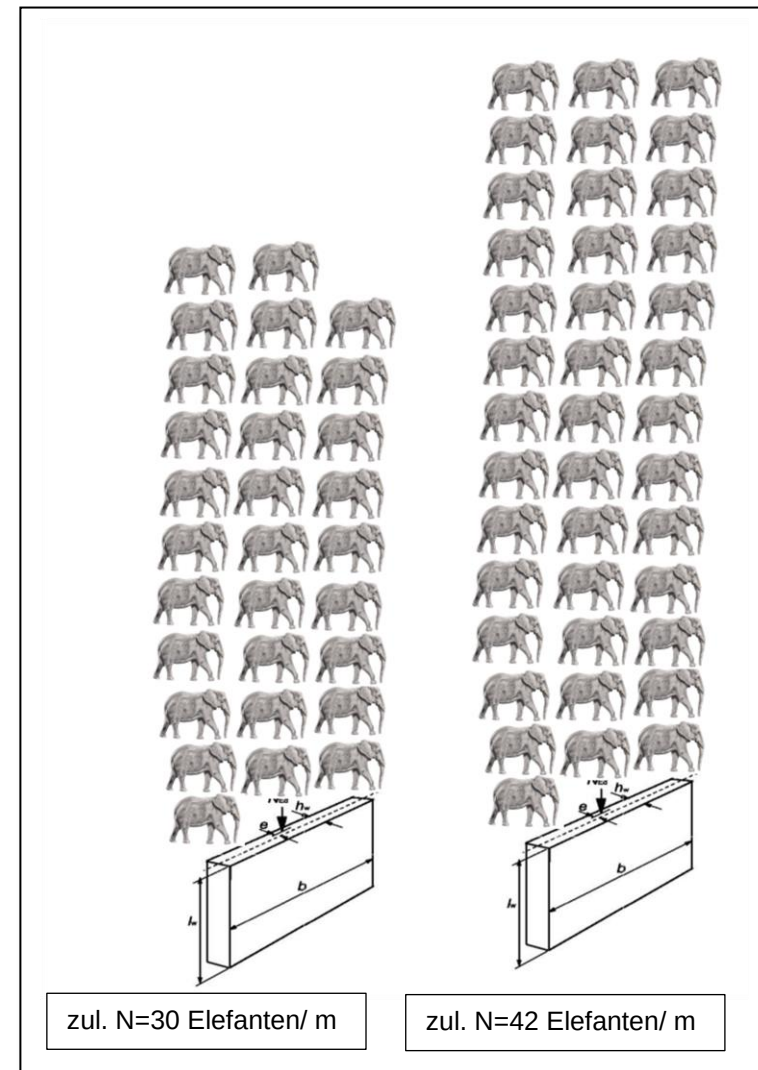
+4, Tragfähigkeit unbewehrte Betonwand, Tragfähigkeit bewehrte Betonwand
